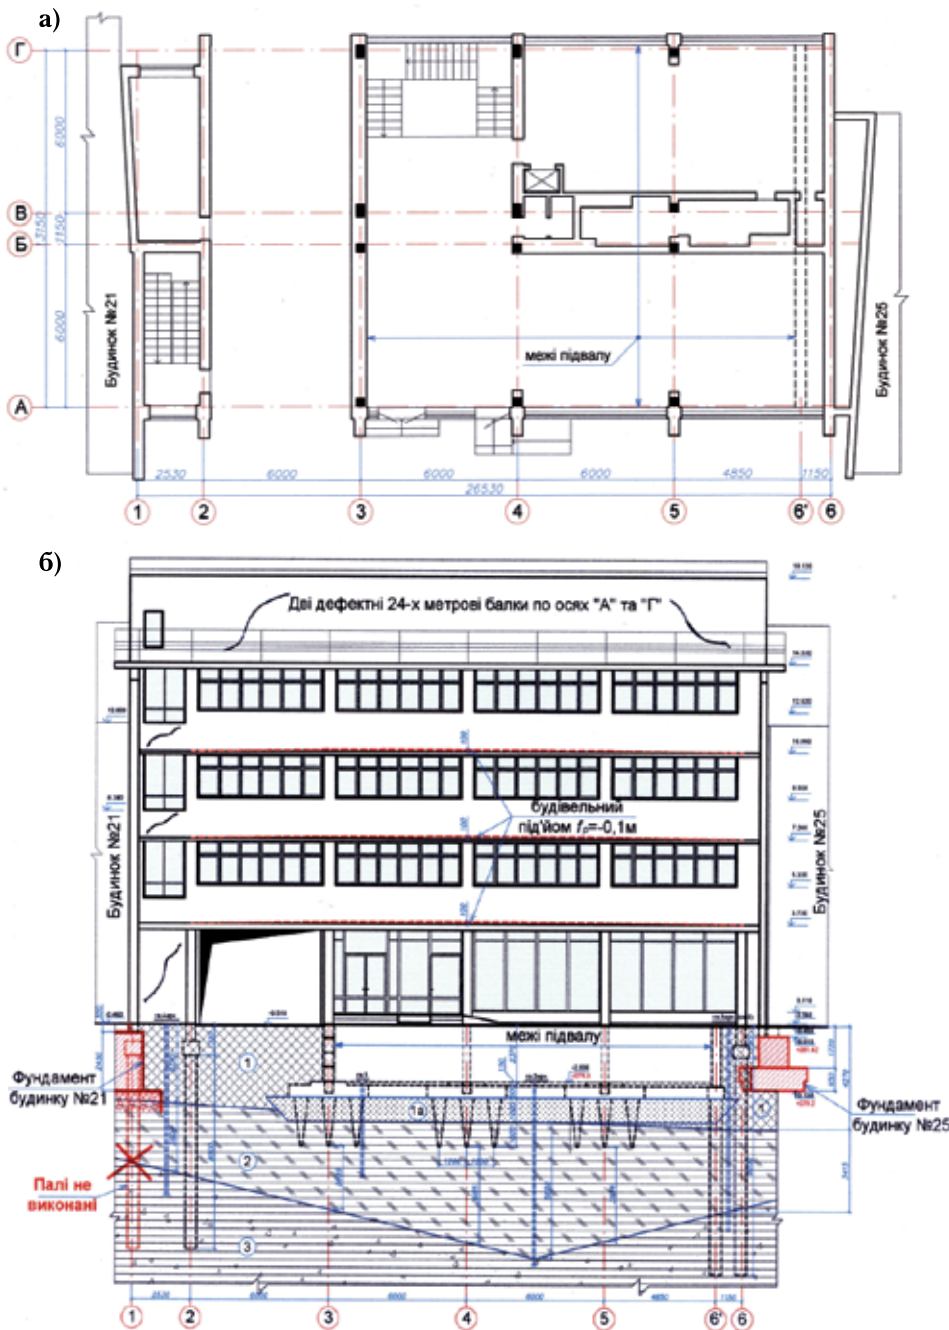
План першого поверху будинку № 23-А – а; головний фасад будинку з підземною його частиною із улаштуванням його фундаментів в межах інженерно-геологічних умов ділянки будівництва – б
